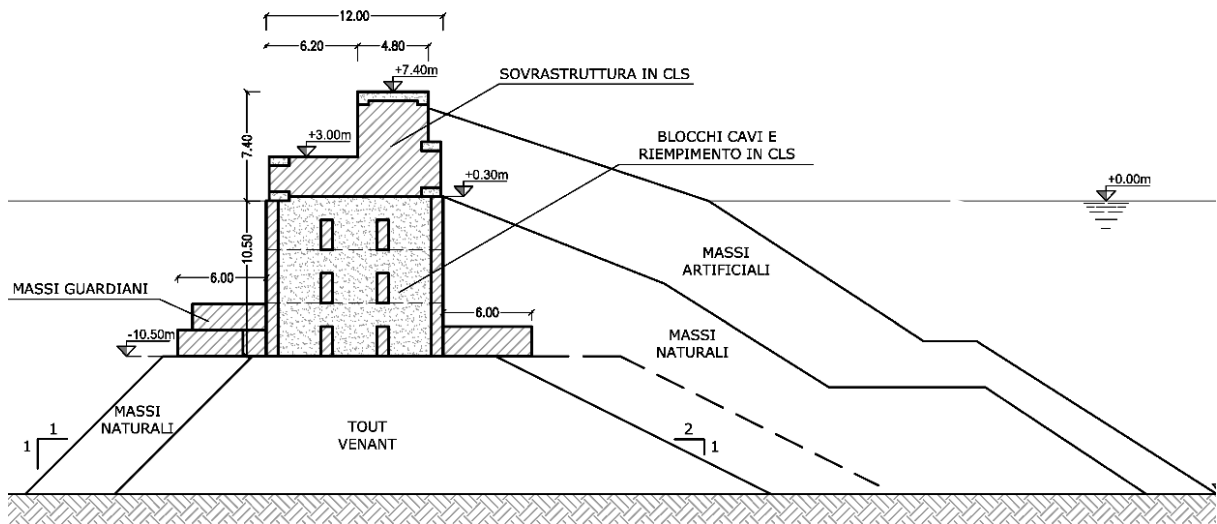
SEZIONE TIPO DEL TRATTO CENTRALE DA DEMOLIRE – TRATTO D-E
